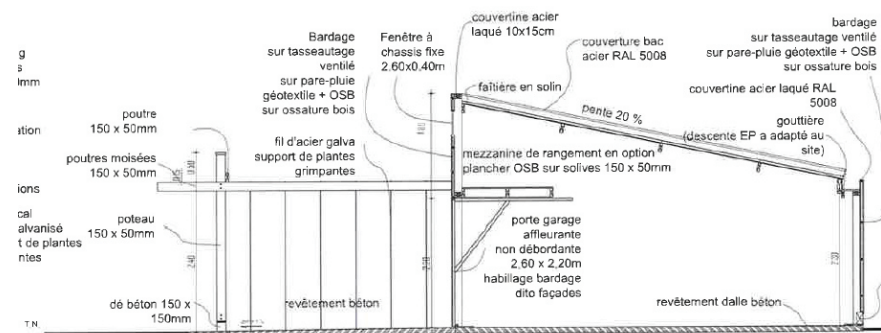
Exemple constructif (document non contractuel) dans le cas d'une construction d'une pergola + garage bois
